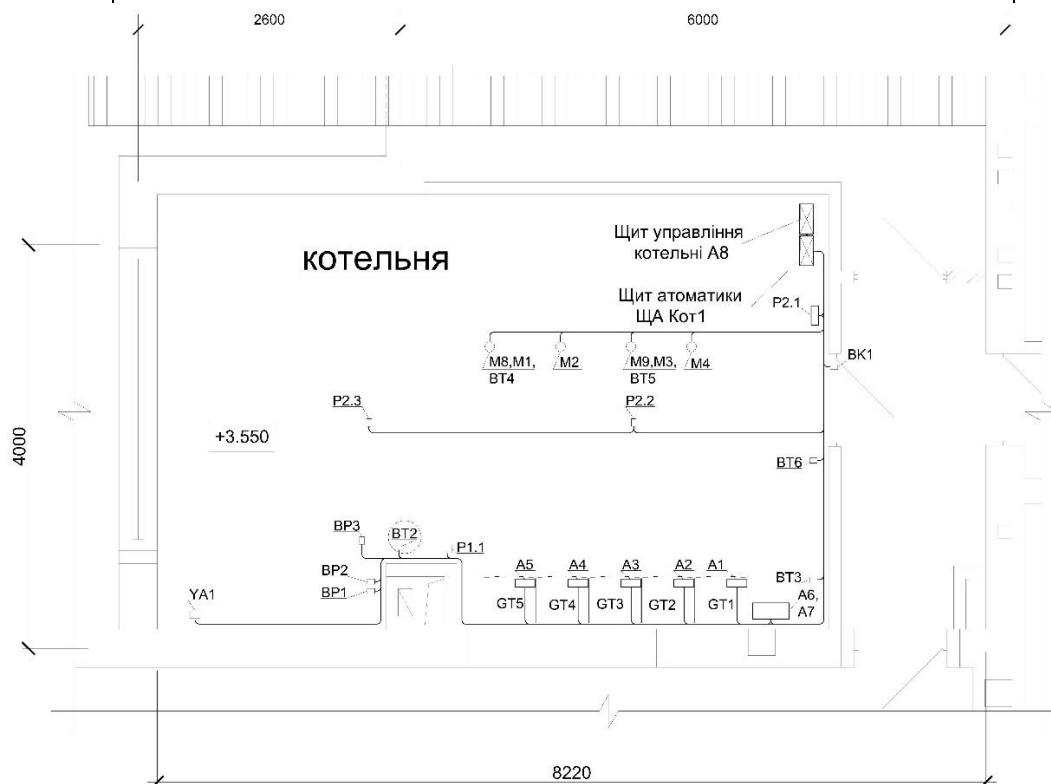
План котельні з розміщенням електрообладнання
